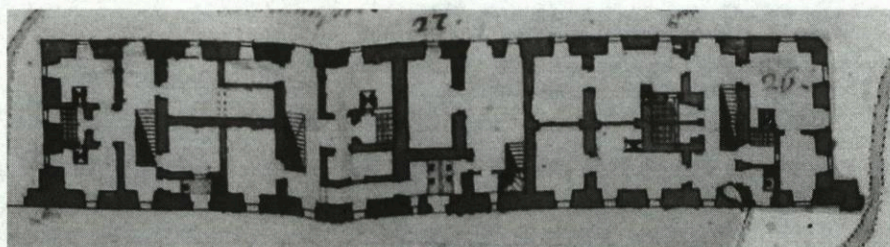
Obermünsterplatz 1-4, Erdgeschoss (Ausschnitt aus dem Münchner Plan, vor 1766).
